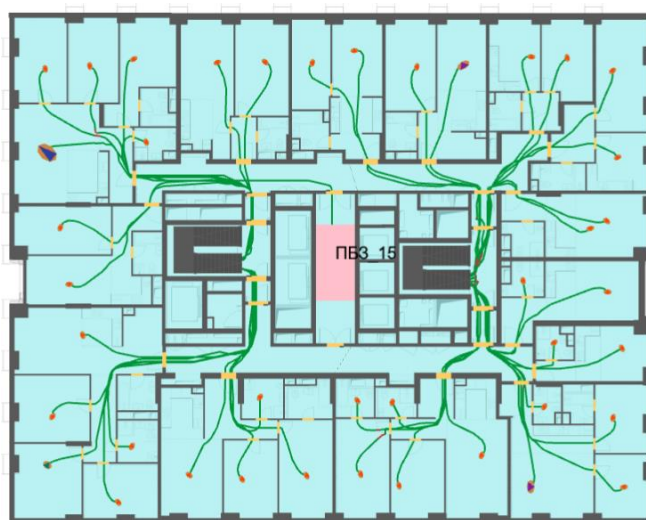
План 14-го этажа и нанесенная на него расчетная (принципиальная) схема эвакуации
